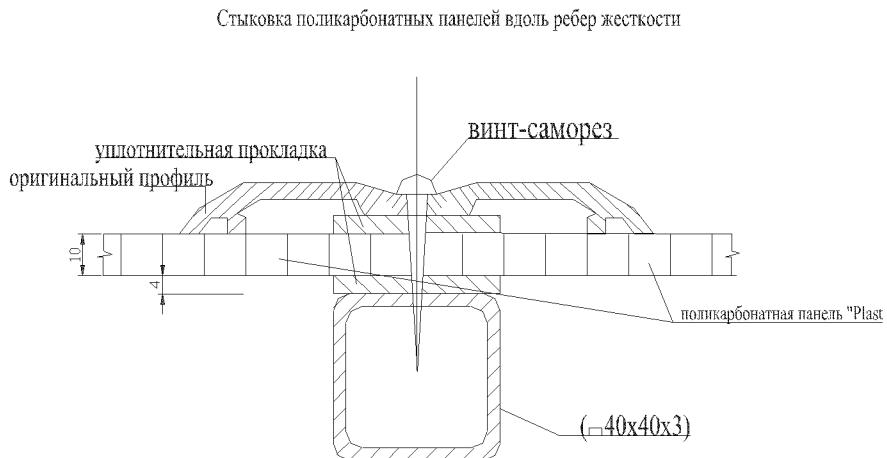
Узел крепления светопрозрачных ограждающих панелей к несущим конструкциям навеса внутреннего дворика.
